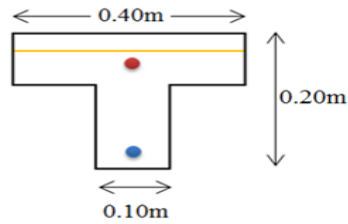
Estado de cargas losa aligerada de Módulo IV
